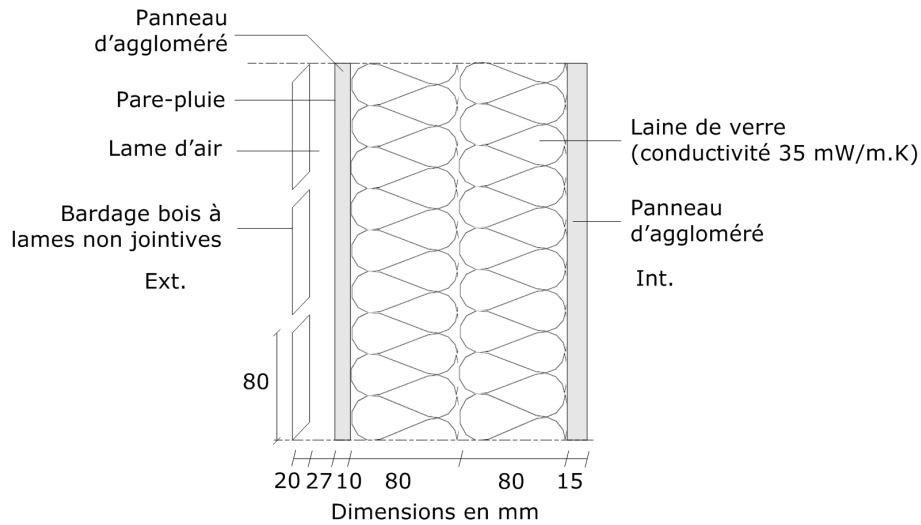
Schéma en coupe d'une paroi verticale, en section courante
